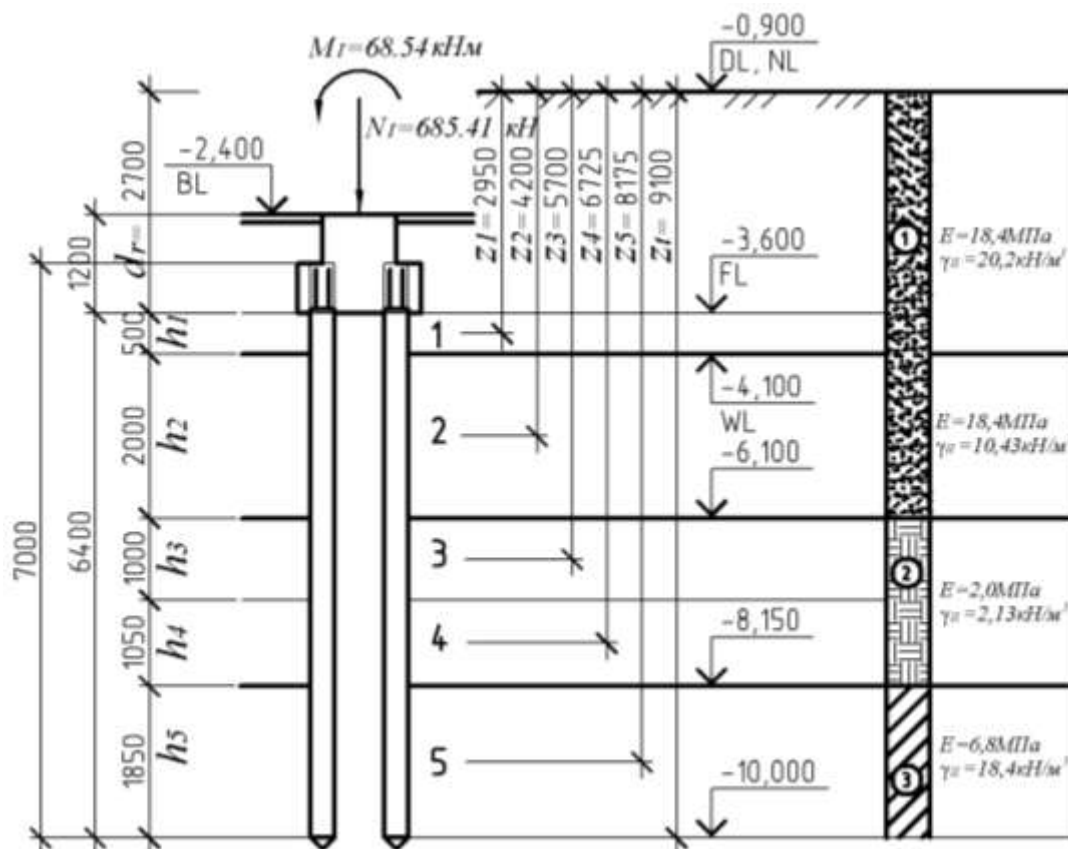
Расчетная схема к примеру 9.1.2.
